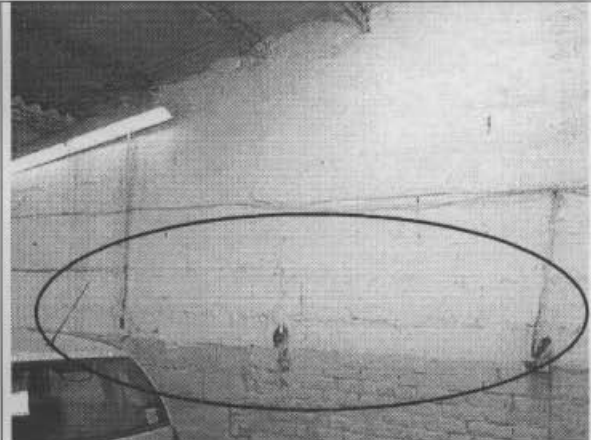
Los muros de carga no evidencian mal comportamiento estructural, pero si, mala calidad de construcción.
